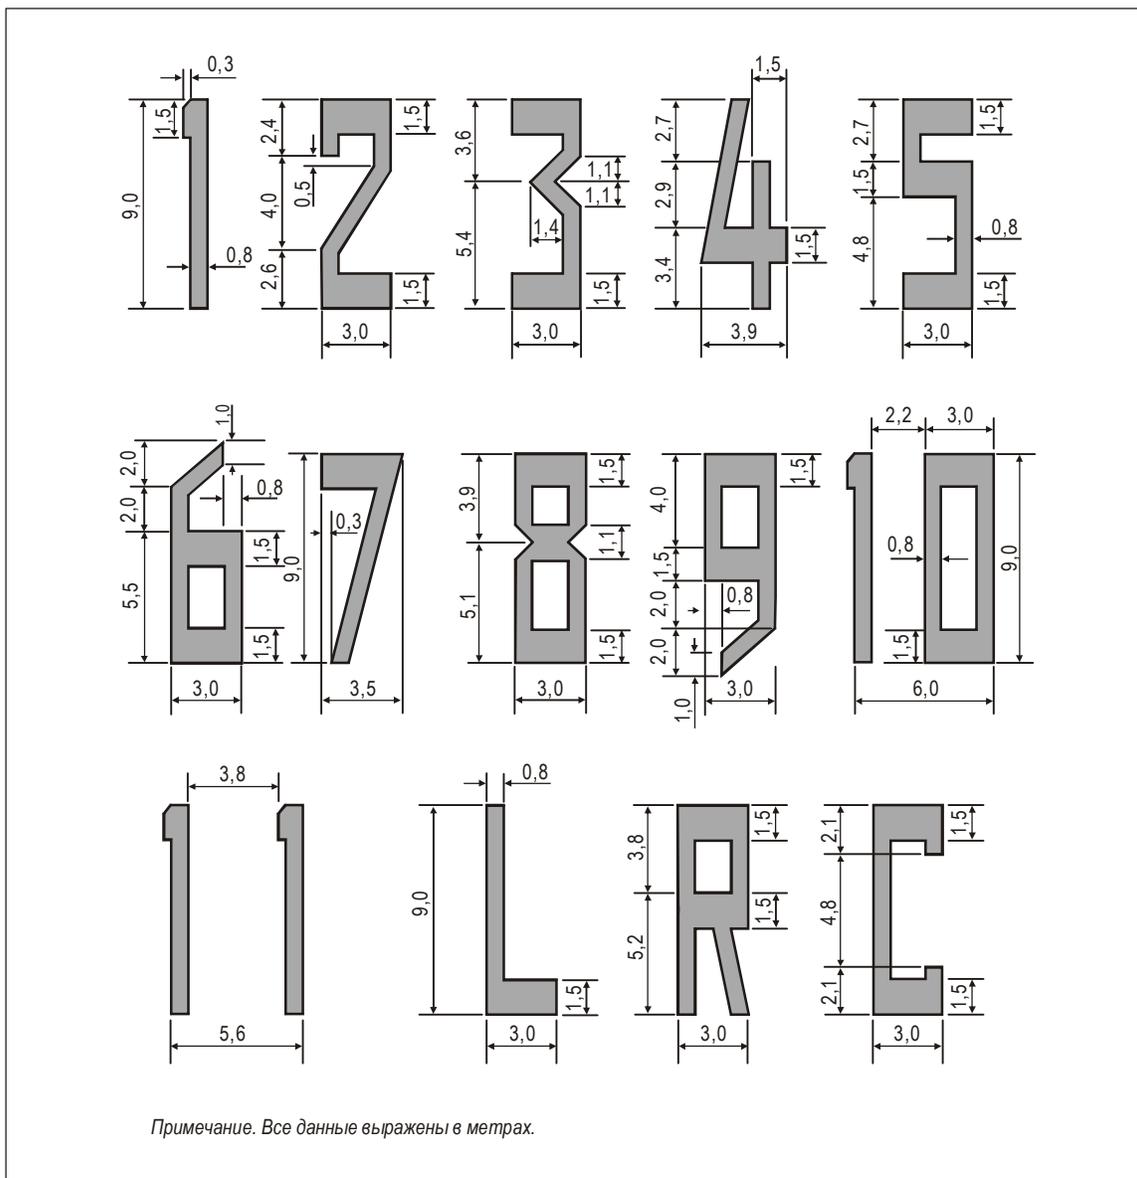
Форма и пропорции цифровых и буквенных знаков, используемых для маркировки обозначения ВПП
